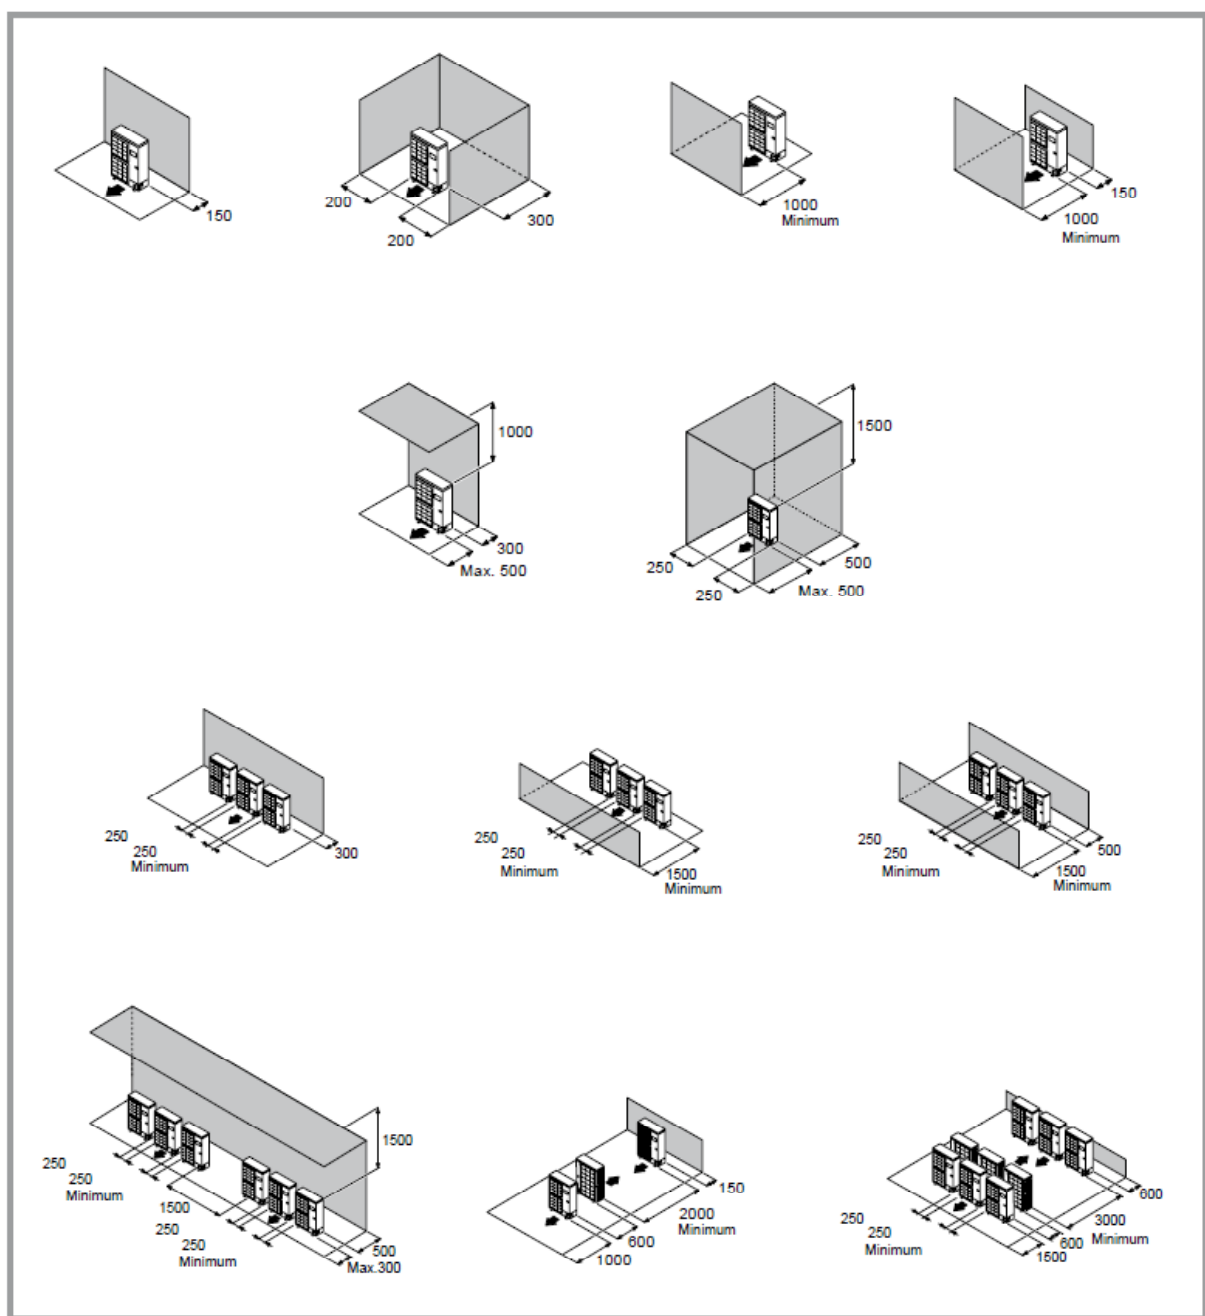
Minsta installationsutrymmen runt aggregatet (alla modeller)
